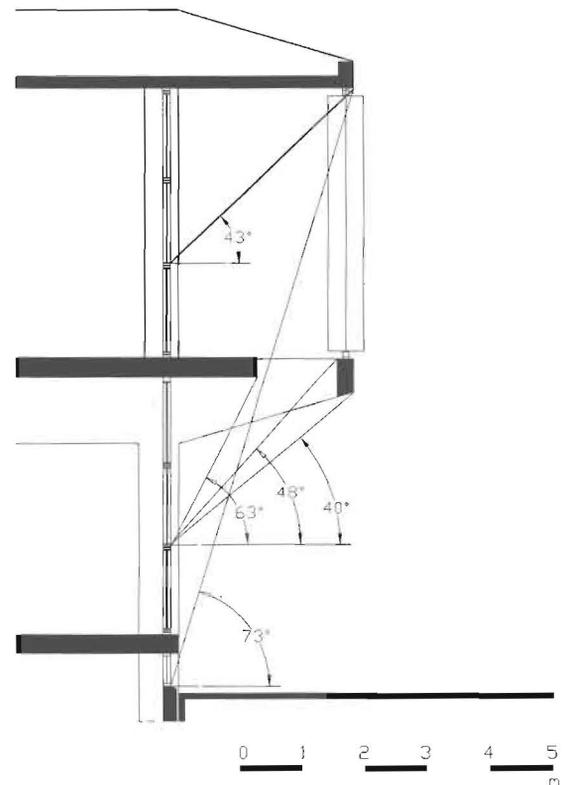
Ángulos de sombra vertical para las fachadas norte y sur del Ala D.
